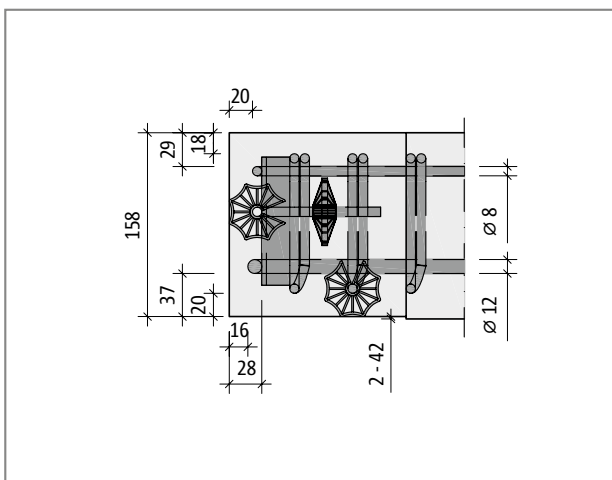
Schöck Tronsole® type Z: Side view of a concrete landing with integrated load-bearing element
